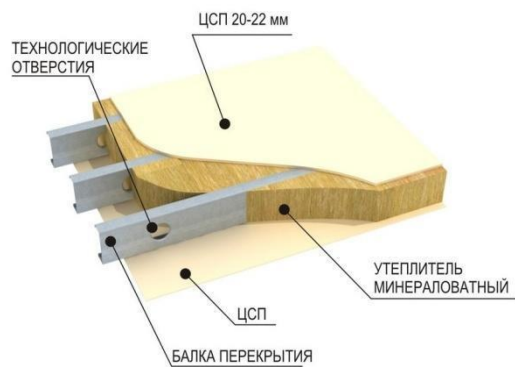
Перекрытие с заполнением минераловатным утеплителем [29]
